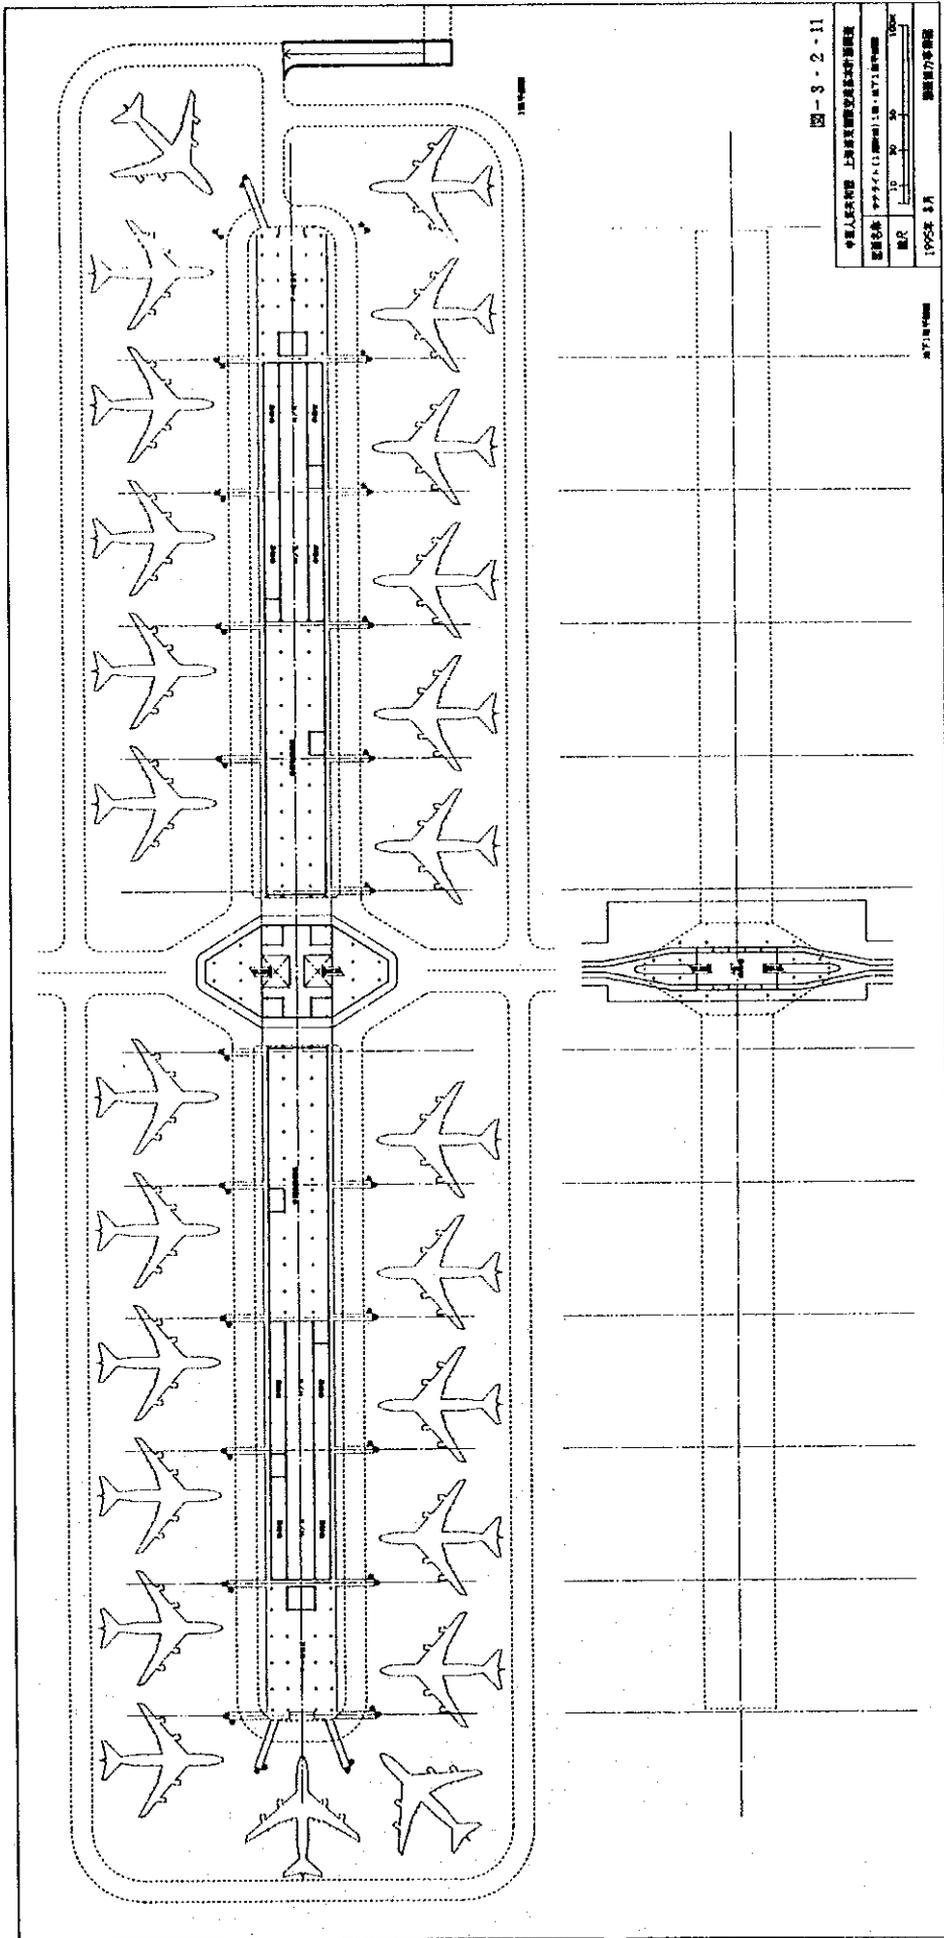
サテライト(1期計画)1階・地下1階平面図
